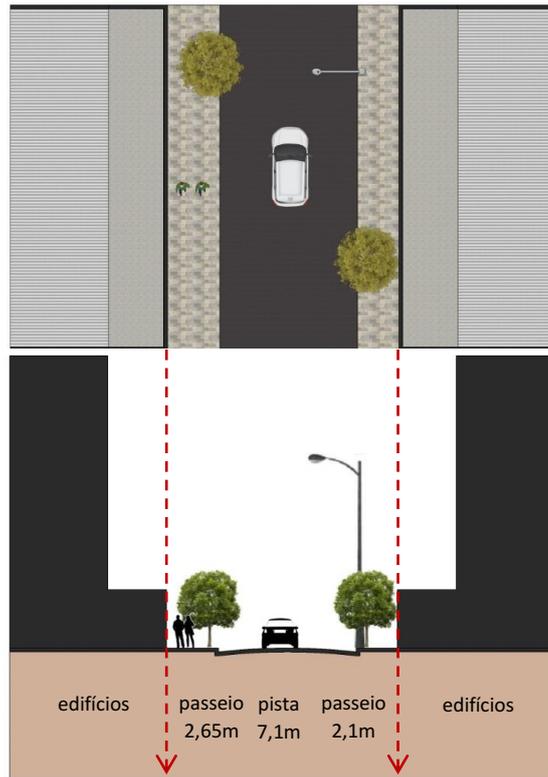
Planta e perfil viário AA da R. Santa Cruz. Fonte: Desenho do autor, 2020.
